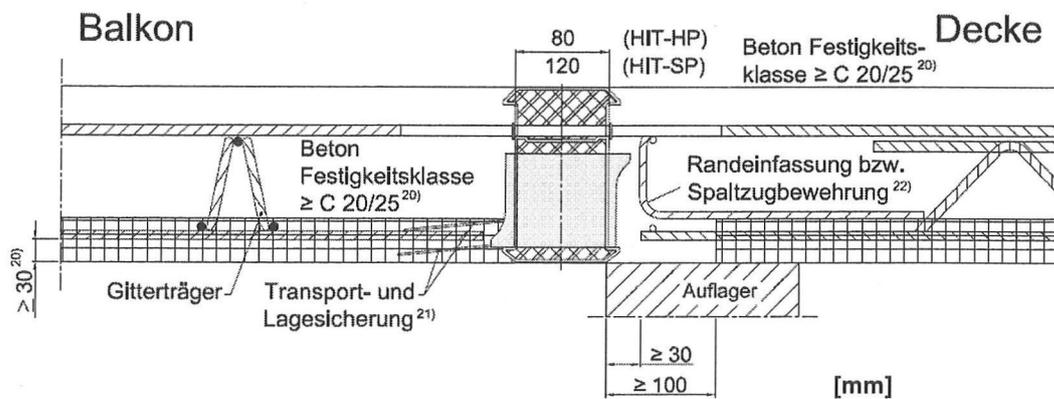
Beispiel für den Anschluss HIT-HP/SP MV F 120/REI 120 an Elementplatten mit statisch - wirksamer Ortbetonschicht
